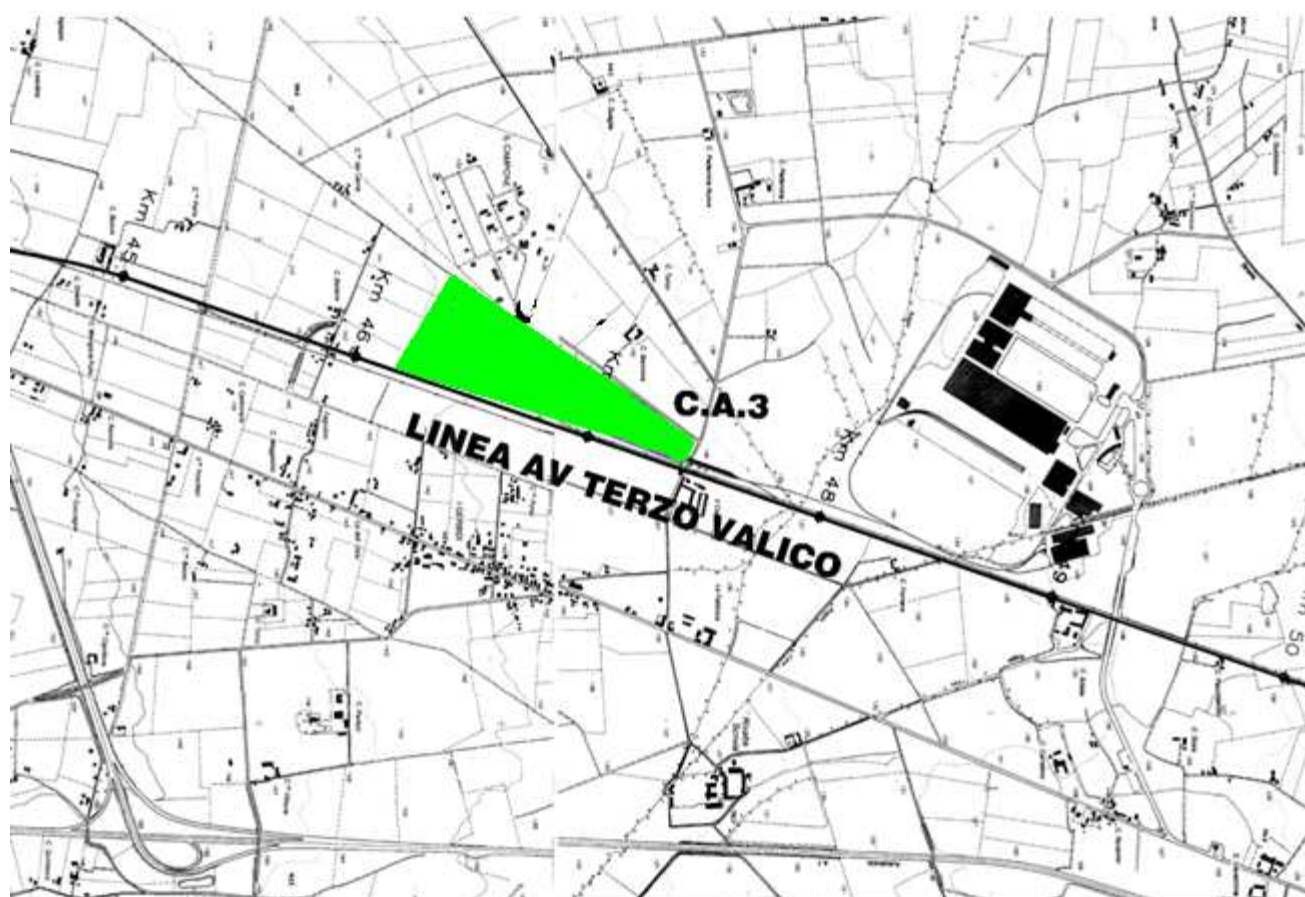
Stralcio planimetrico con indicazione del Cantiere di armamento C.A.3 per la soluzione di variante
